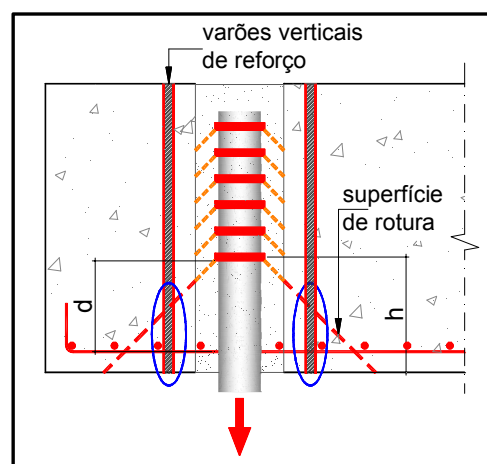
Pormenorização proposta para os varões verticais de reforço
